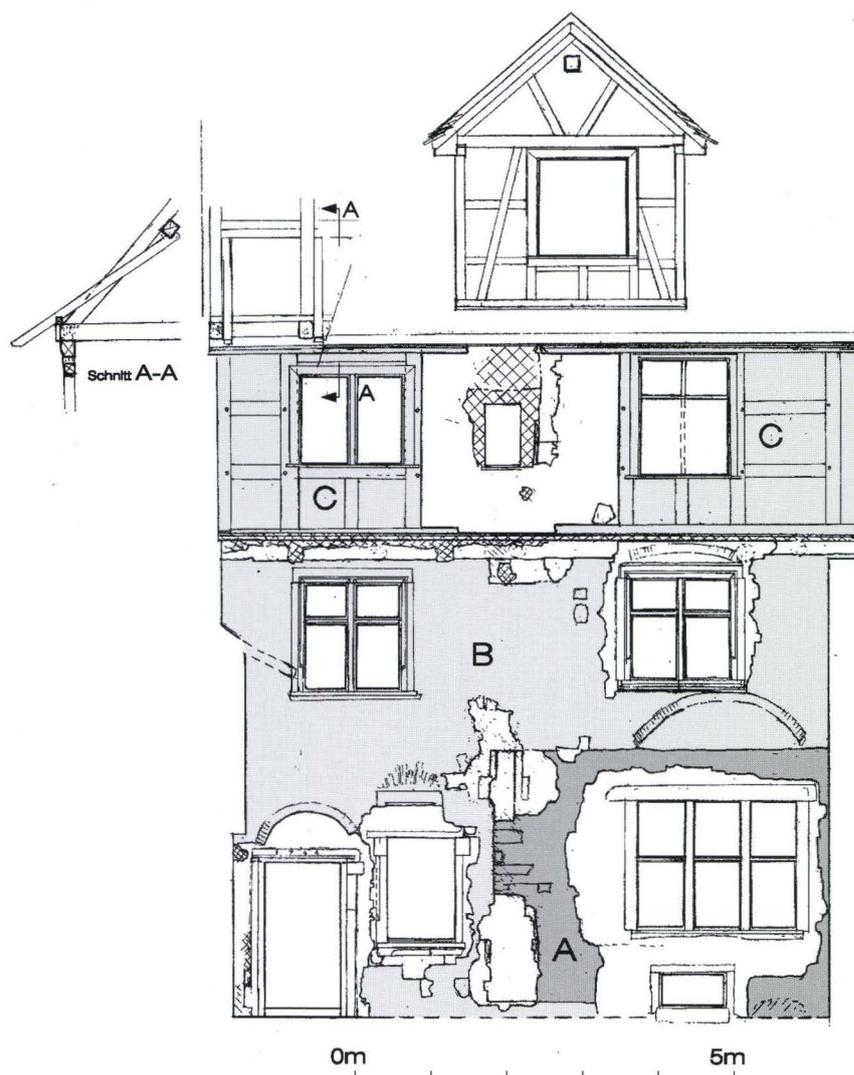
Gernsberg 9. Plan der Rückfassade mit baugeschichtlichem Befund. – Zeichnung: Matthias Merki. – Massstab 1:100.
